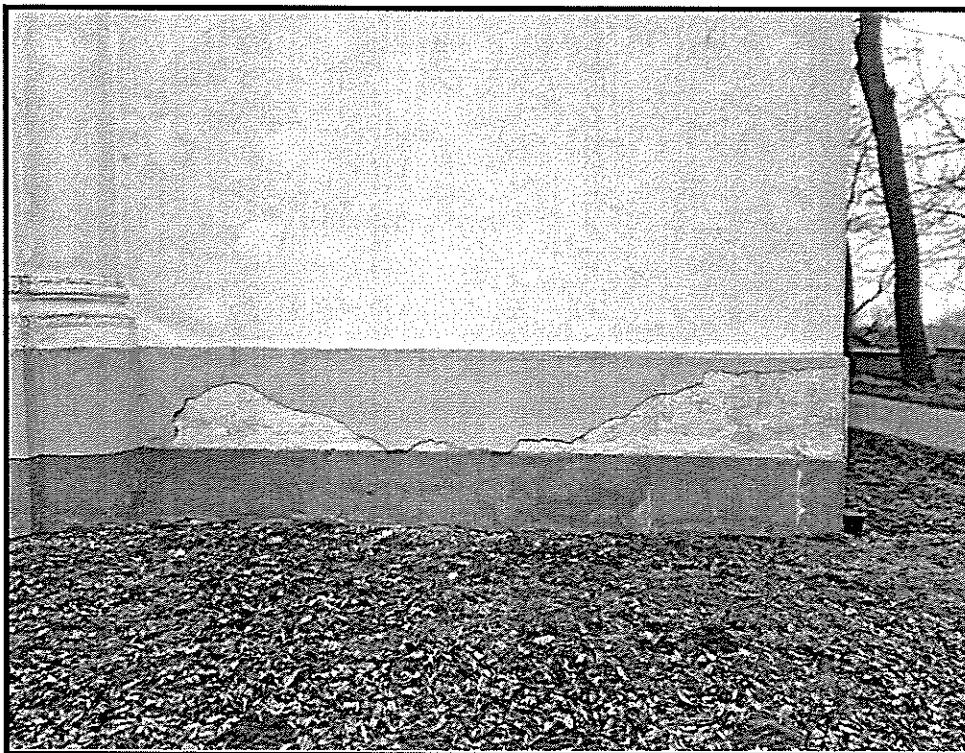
Stan zachowania elewacji wschodniej z lokalizacją dwóch okienek piwnicznych.
